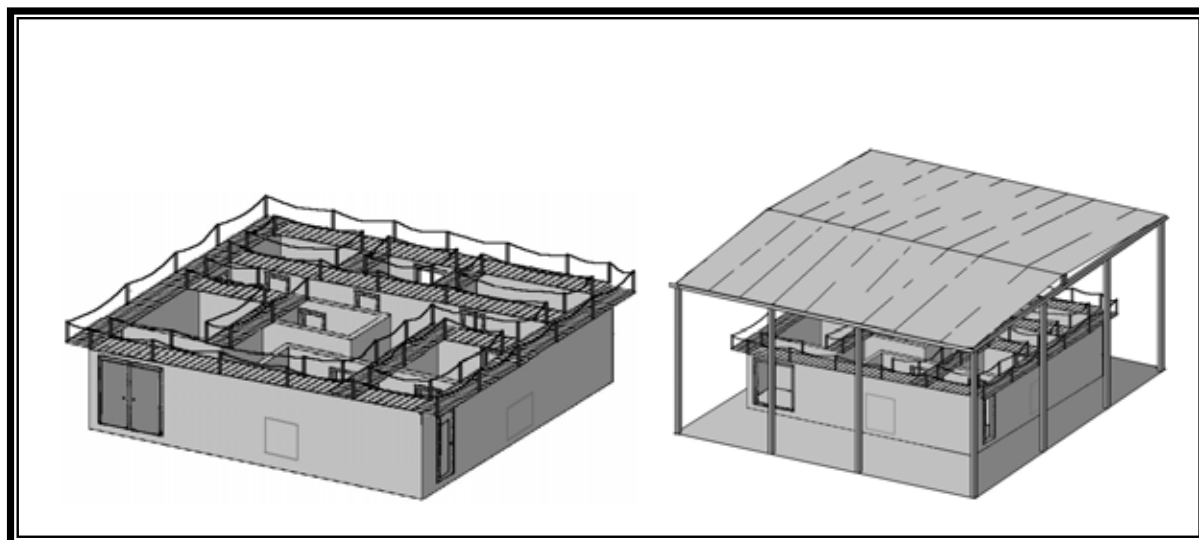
Infra-estruturas projectadas para o CAE (vista Oeste)
